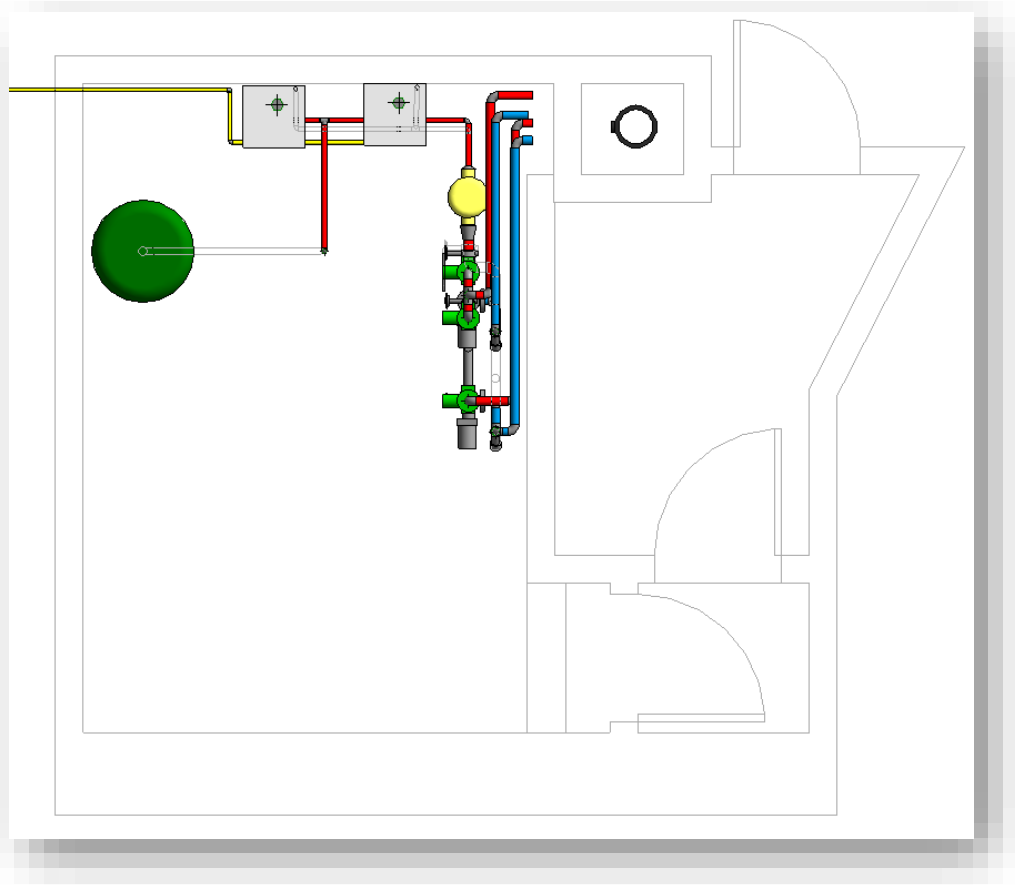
Planta sala de calderas Banco de España en Valladolid
